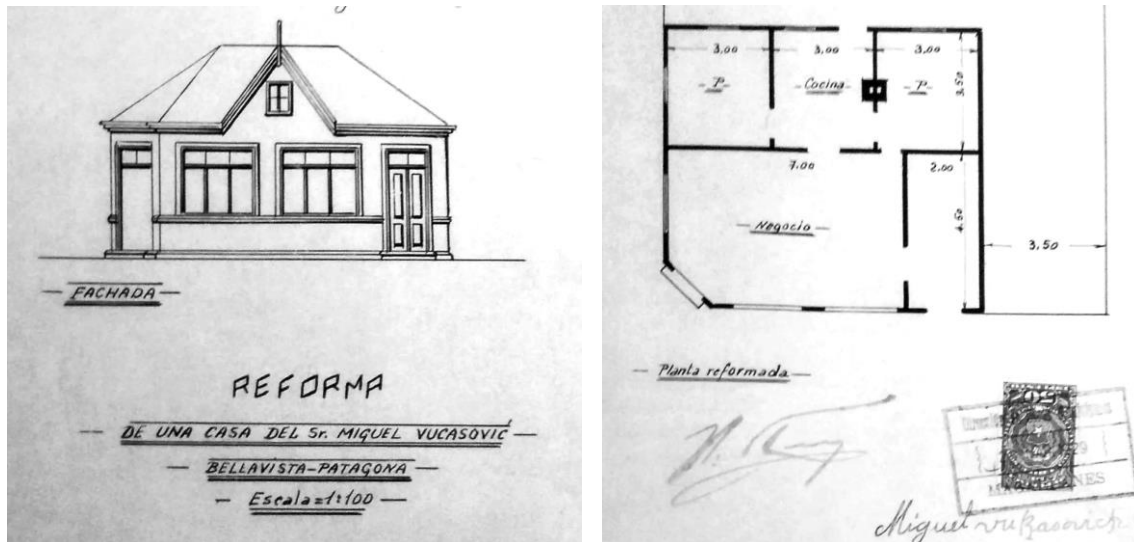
y 30: Planta y Sección plano original de la Vivienda en Bellavista nº94-98 esquina en chaflán esquema patagónico
